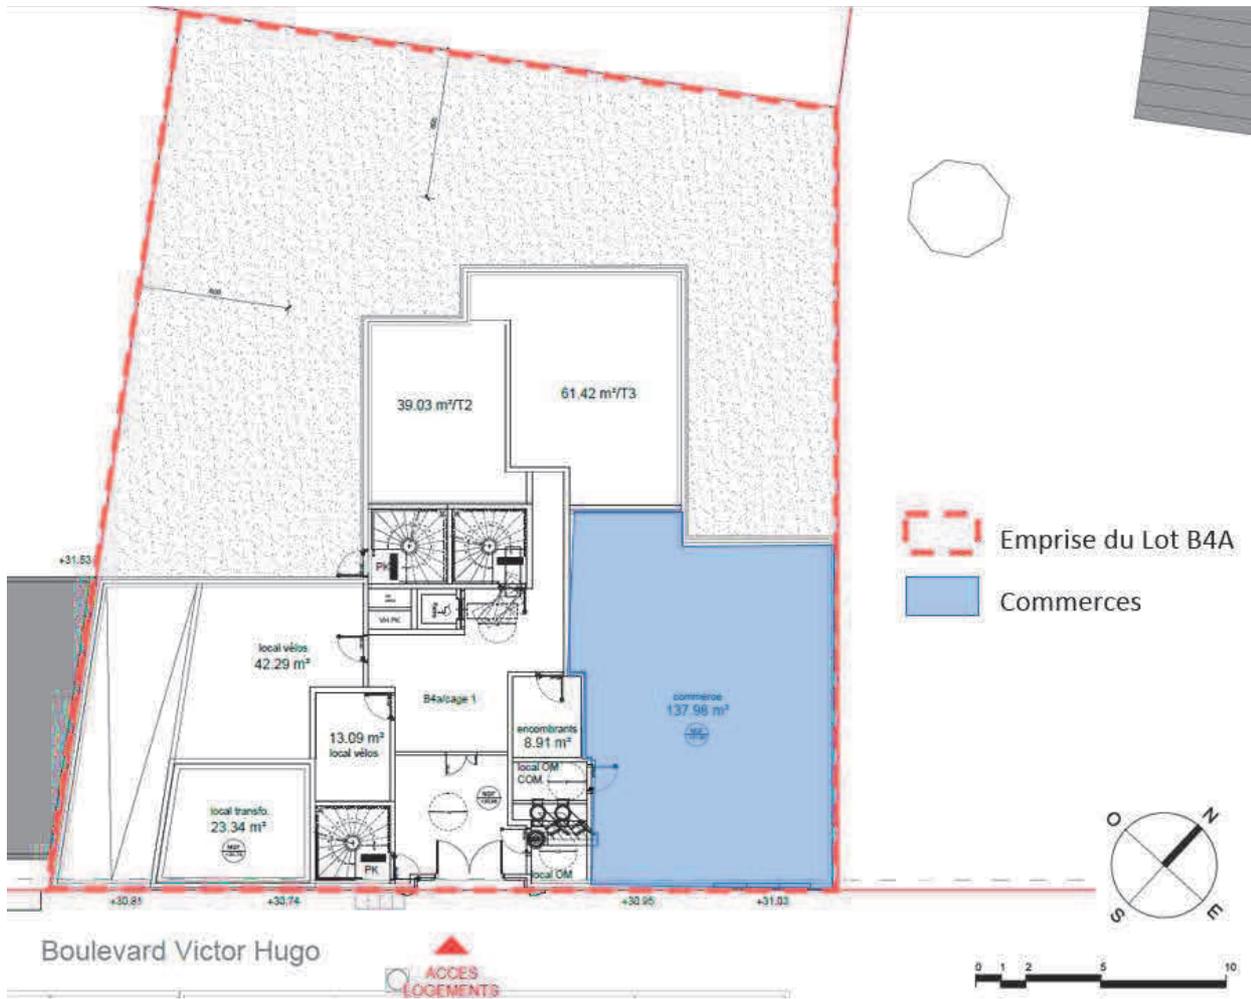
Plan du rez-de-chaussée du Lot B4A (Source : DGM)
